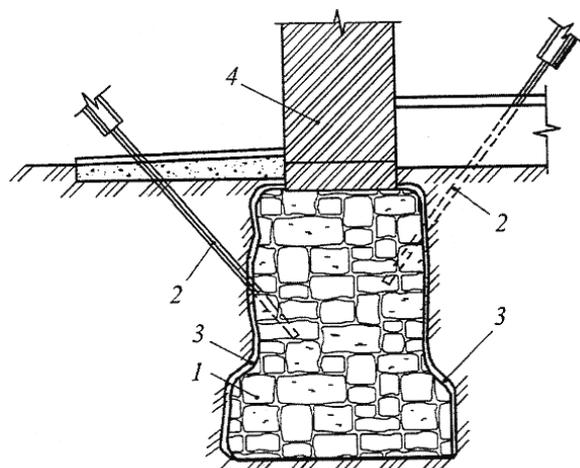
Закрепление цементной кладки фундамента цементацией: 1 – усиливаемый фундамент; 2 – инъекторы для нагнетания жидкого цементного раствора; 3 – наплывы раствора; 4 – кирпичная стена
